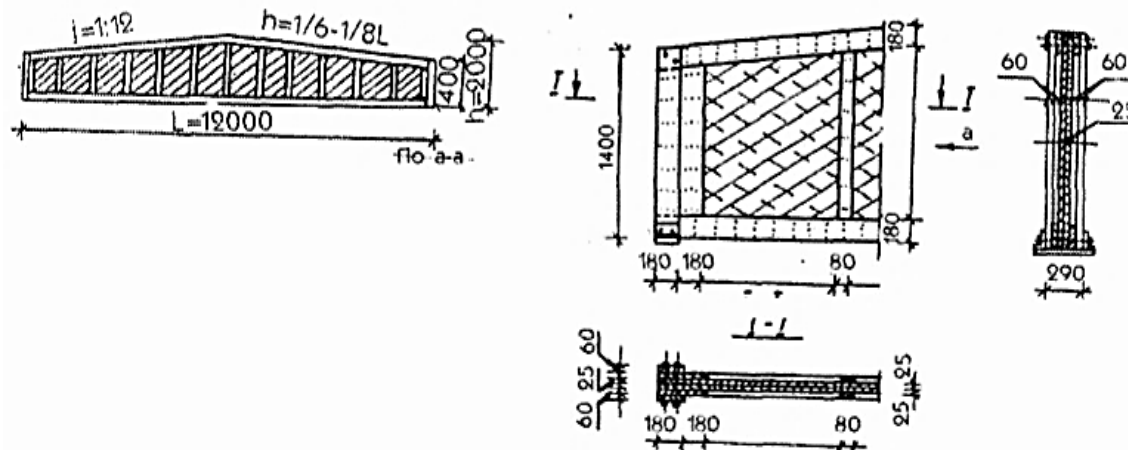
Деревянная балка из досок на гвоздях
